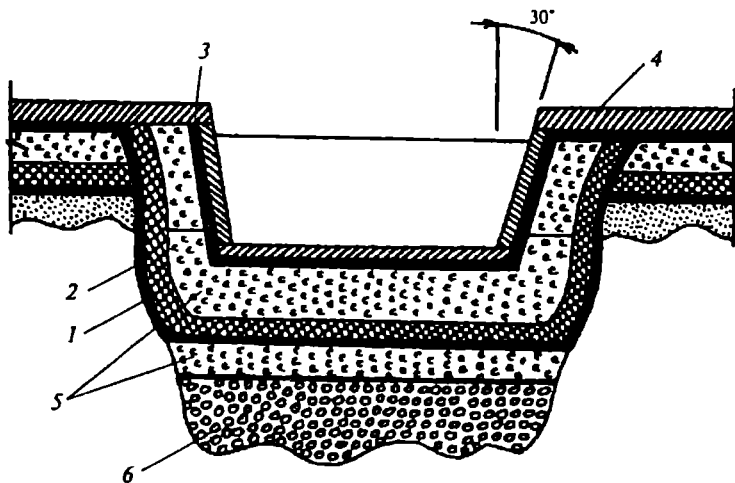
Бетонный бассейн с уклоном стенок до 30°:
